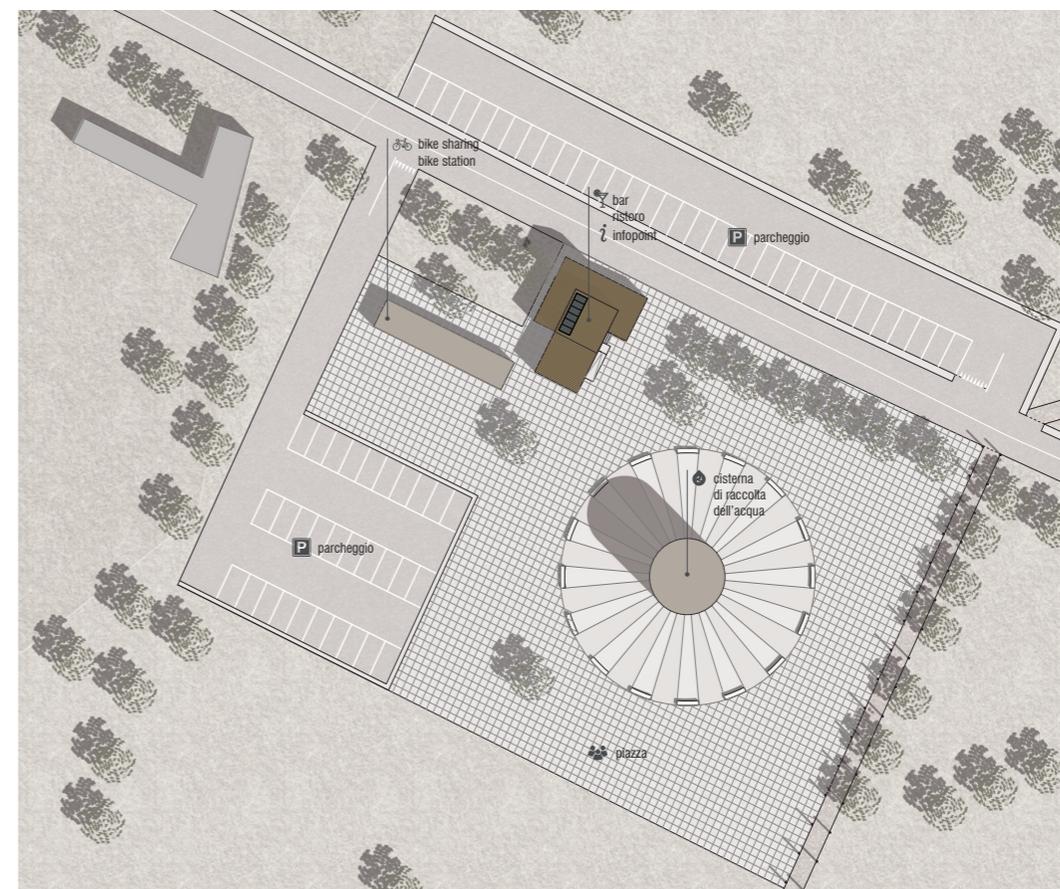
Planivolumetrico 1:1000 e distribuzione funzionale
